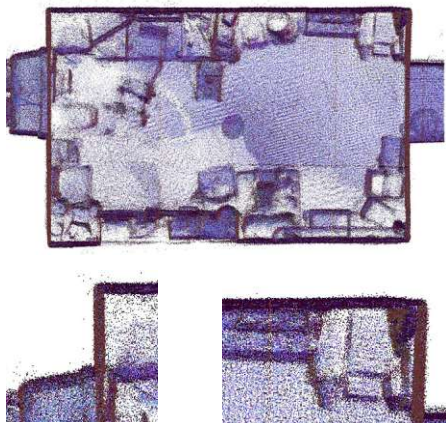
Grundriss eines Raumes (SLAM-Punktwolke)
